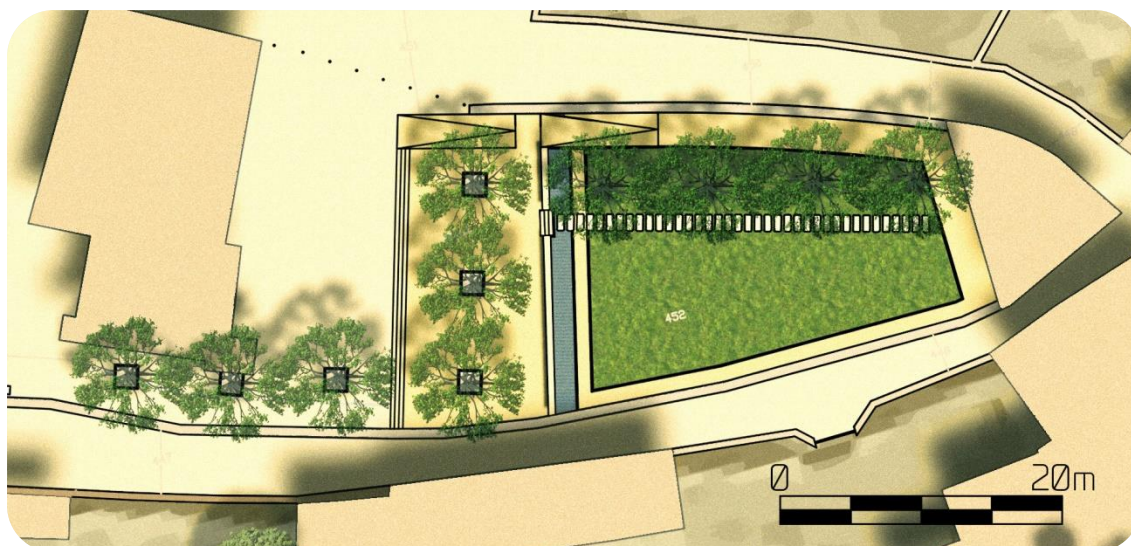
Planta do Jardim da Igreja de Sta. Maria
